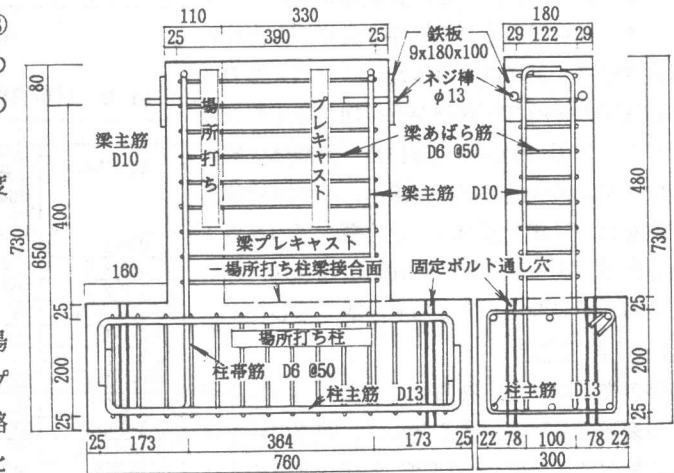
試験体の概要及び配筋 (HB-8-2・2-B)
